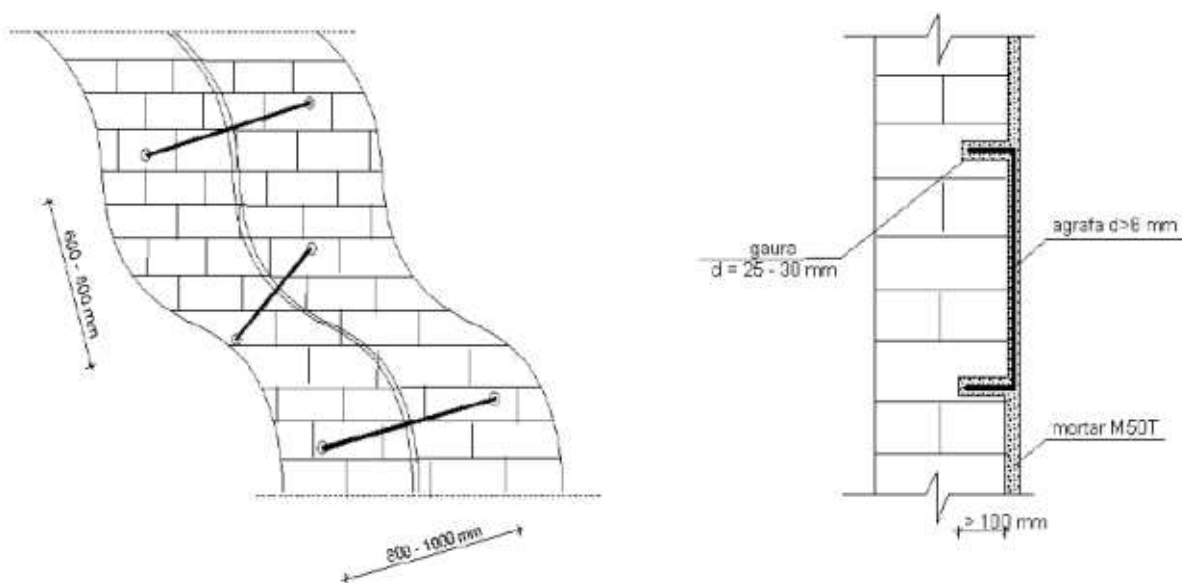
Detaliu de remediere a fisurilor cu agrafe din otel-beton
